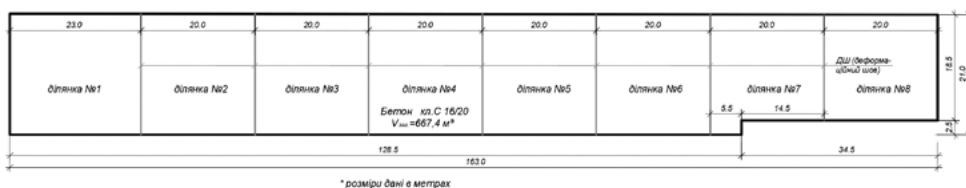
Опалубний план монолітної цементобетонної плити майданчика
